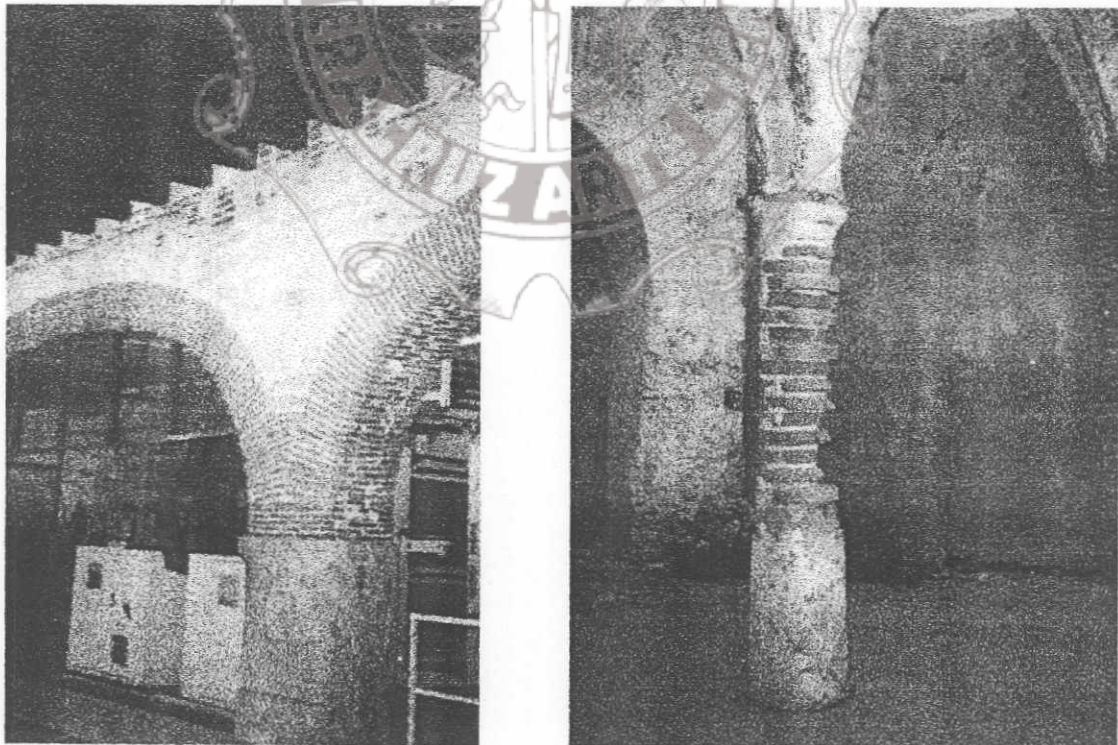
Arquerías y columnas de diámetro variable.
